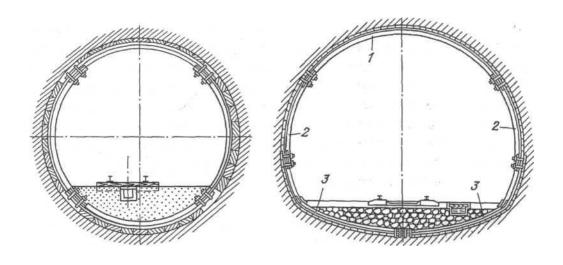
Конструкции кольцевой металлической податливой крепи
